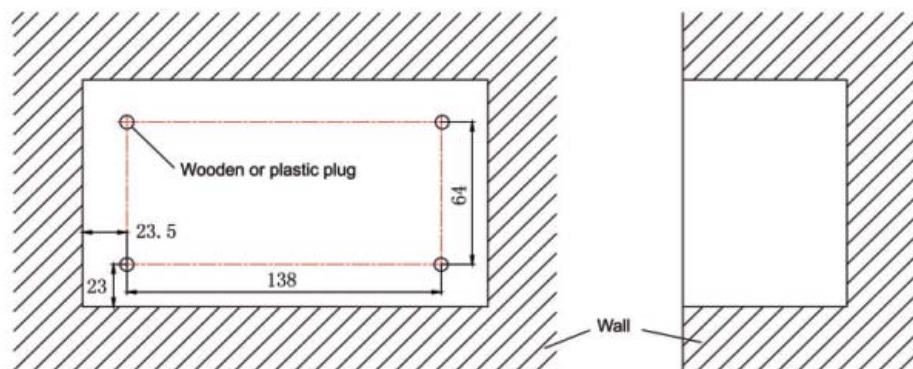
Schema für die Bohrungen zur Wandbefestigung
